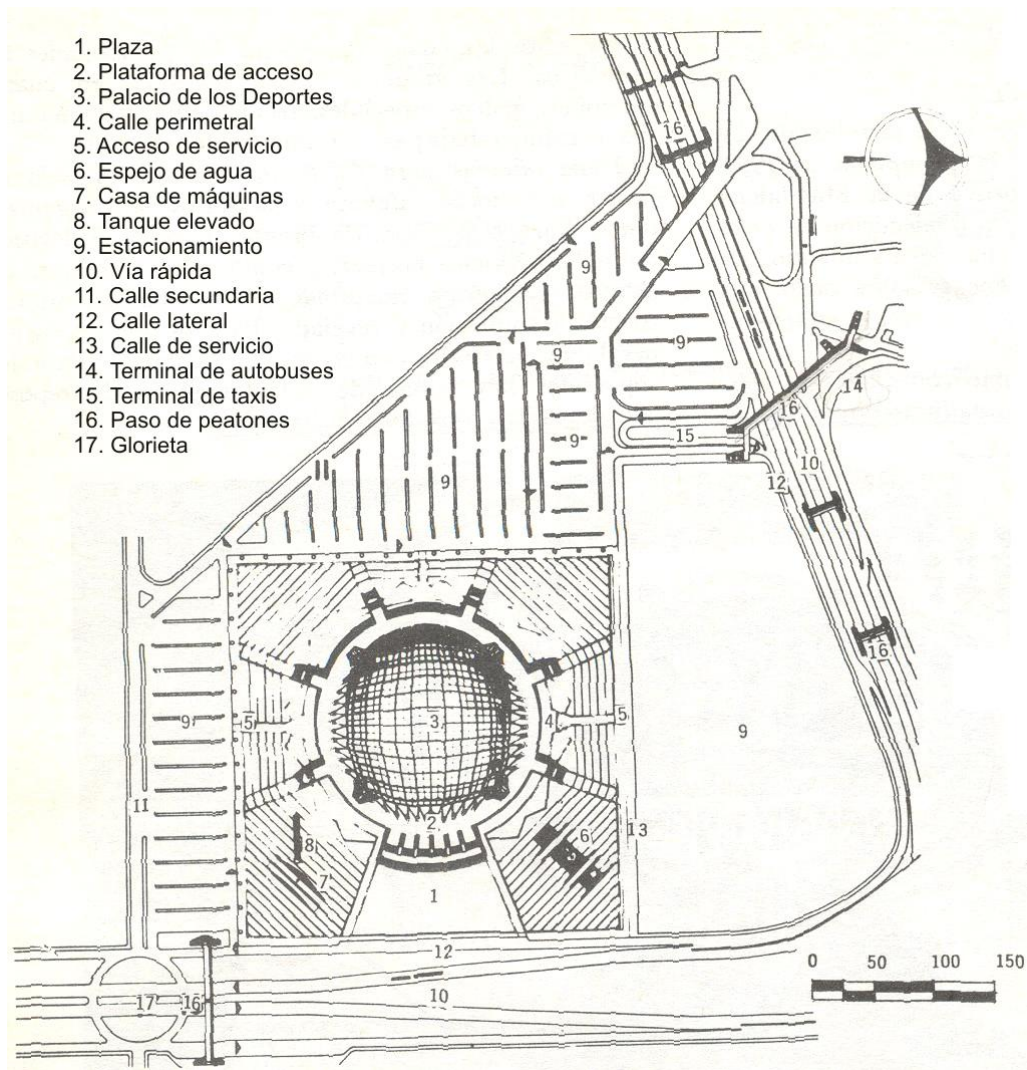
Planta de conjunto del Palacio de los Deportes
